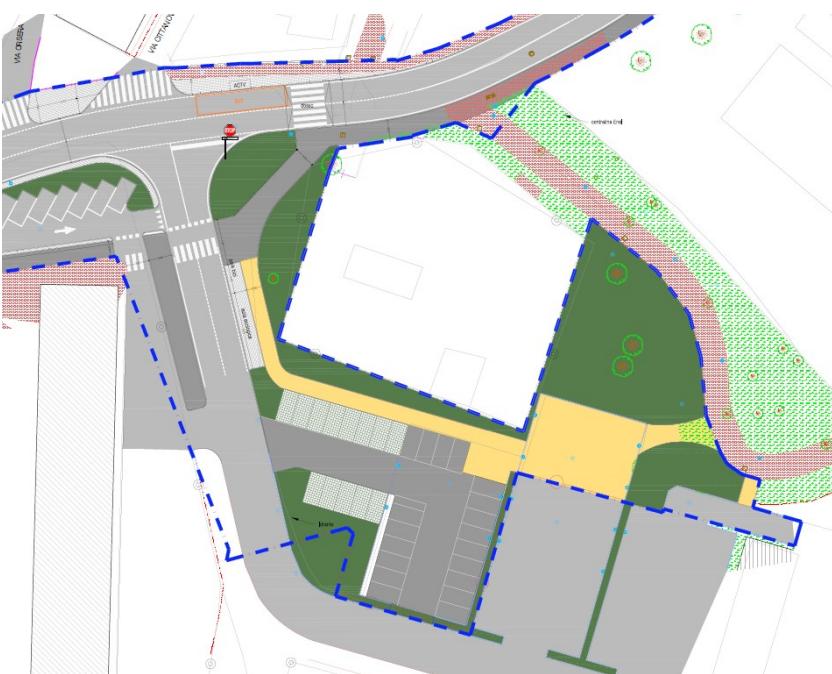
Estratto della planimetria di progetto definitivo dell'intervento denominato C.I. 14585 "Realizzazione pista ciclopedonale di via Assegiano"
